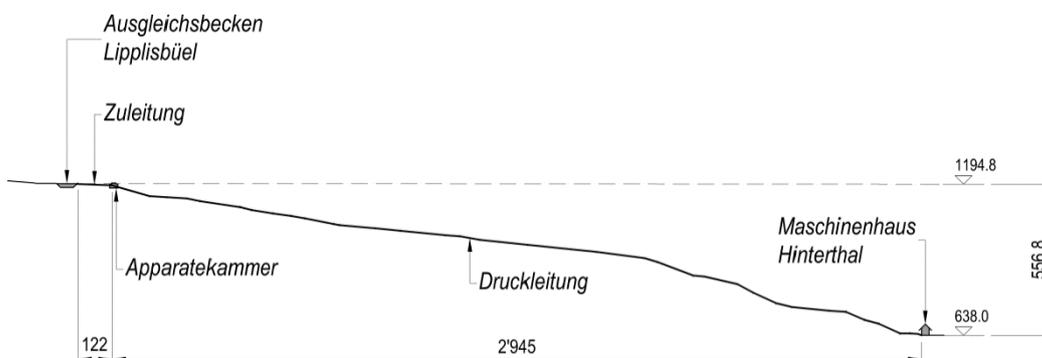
Schematisches Längenprofil des bestehenden Triebwassersystems.
